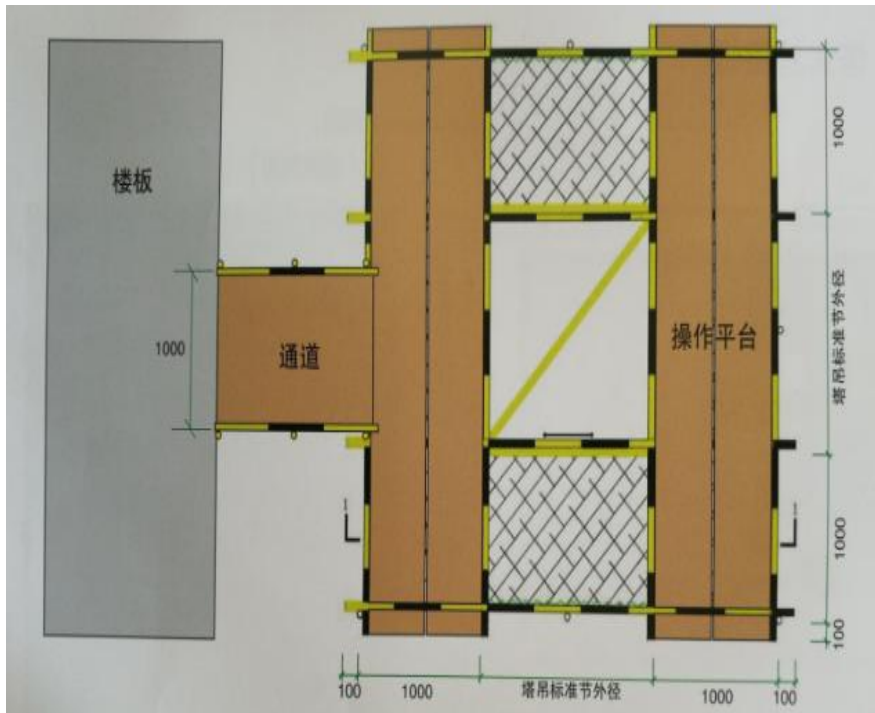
钢管脚手架式塔式起重机附墙安装上人通道、平台示意图
